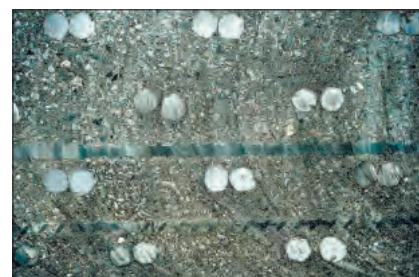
Укладка самоуплотняющегося бетона класса В50 в густоармированную конструкцию фундаментной плиты высотой 4 м, объемом 14,2 тыс. м³ с расходом арматуры 270 кг/м³ башни «Восток» МК Федерация
